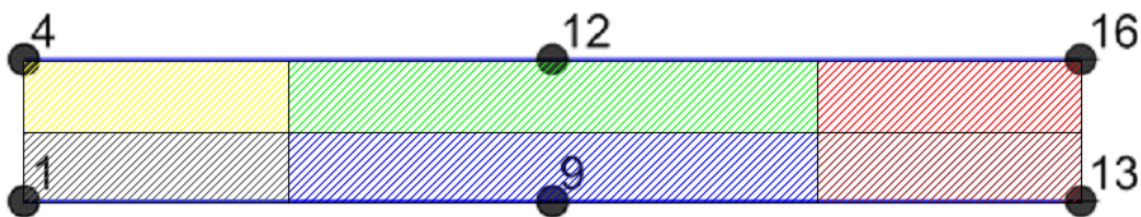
Vista en planta del tablero de acero para el puente. En esta imagen se pueden apreciar los nodos en donde se aplicaron las cargas puntuales y las áreas tributarias de los mismos.
